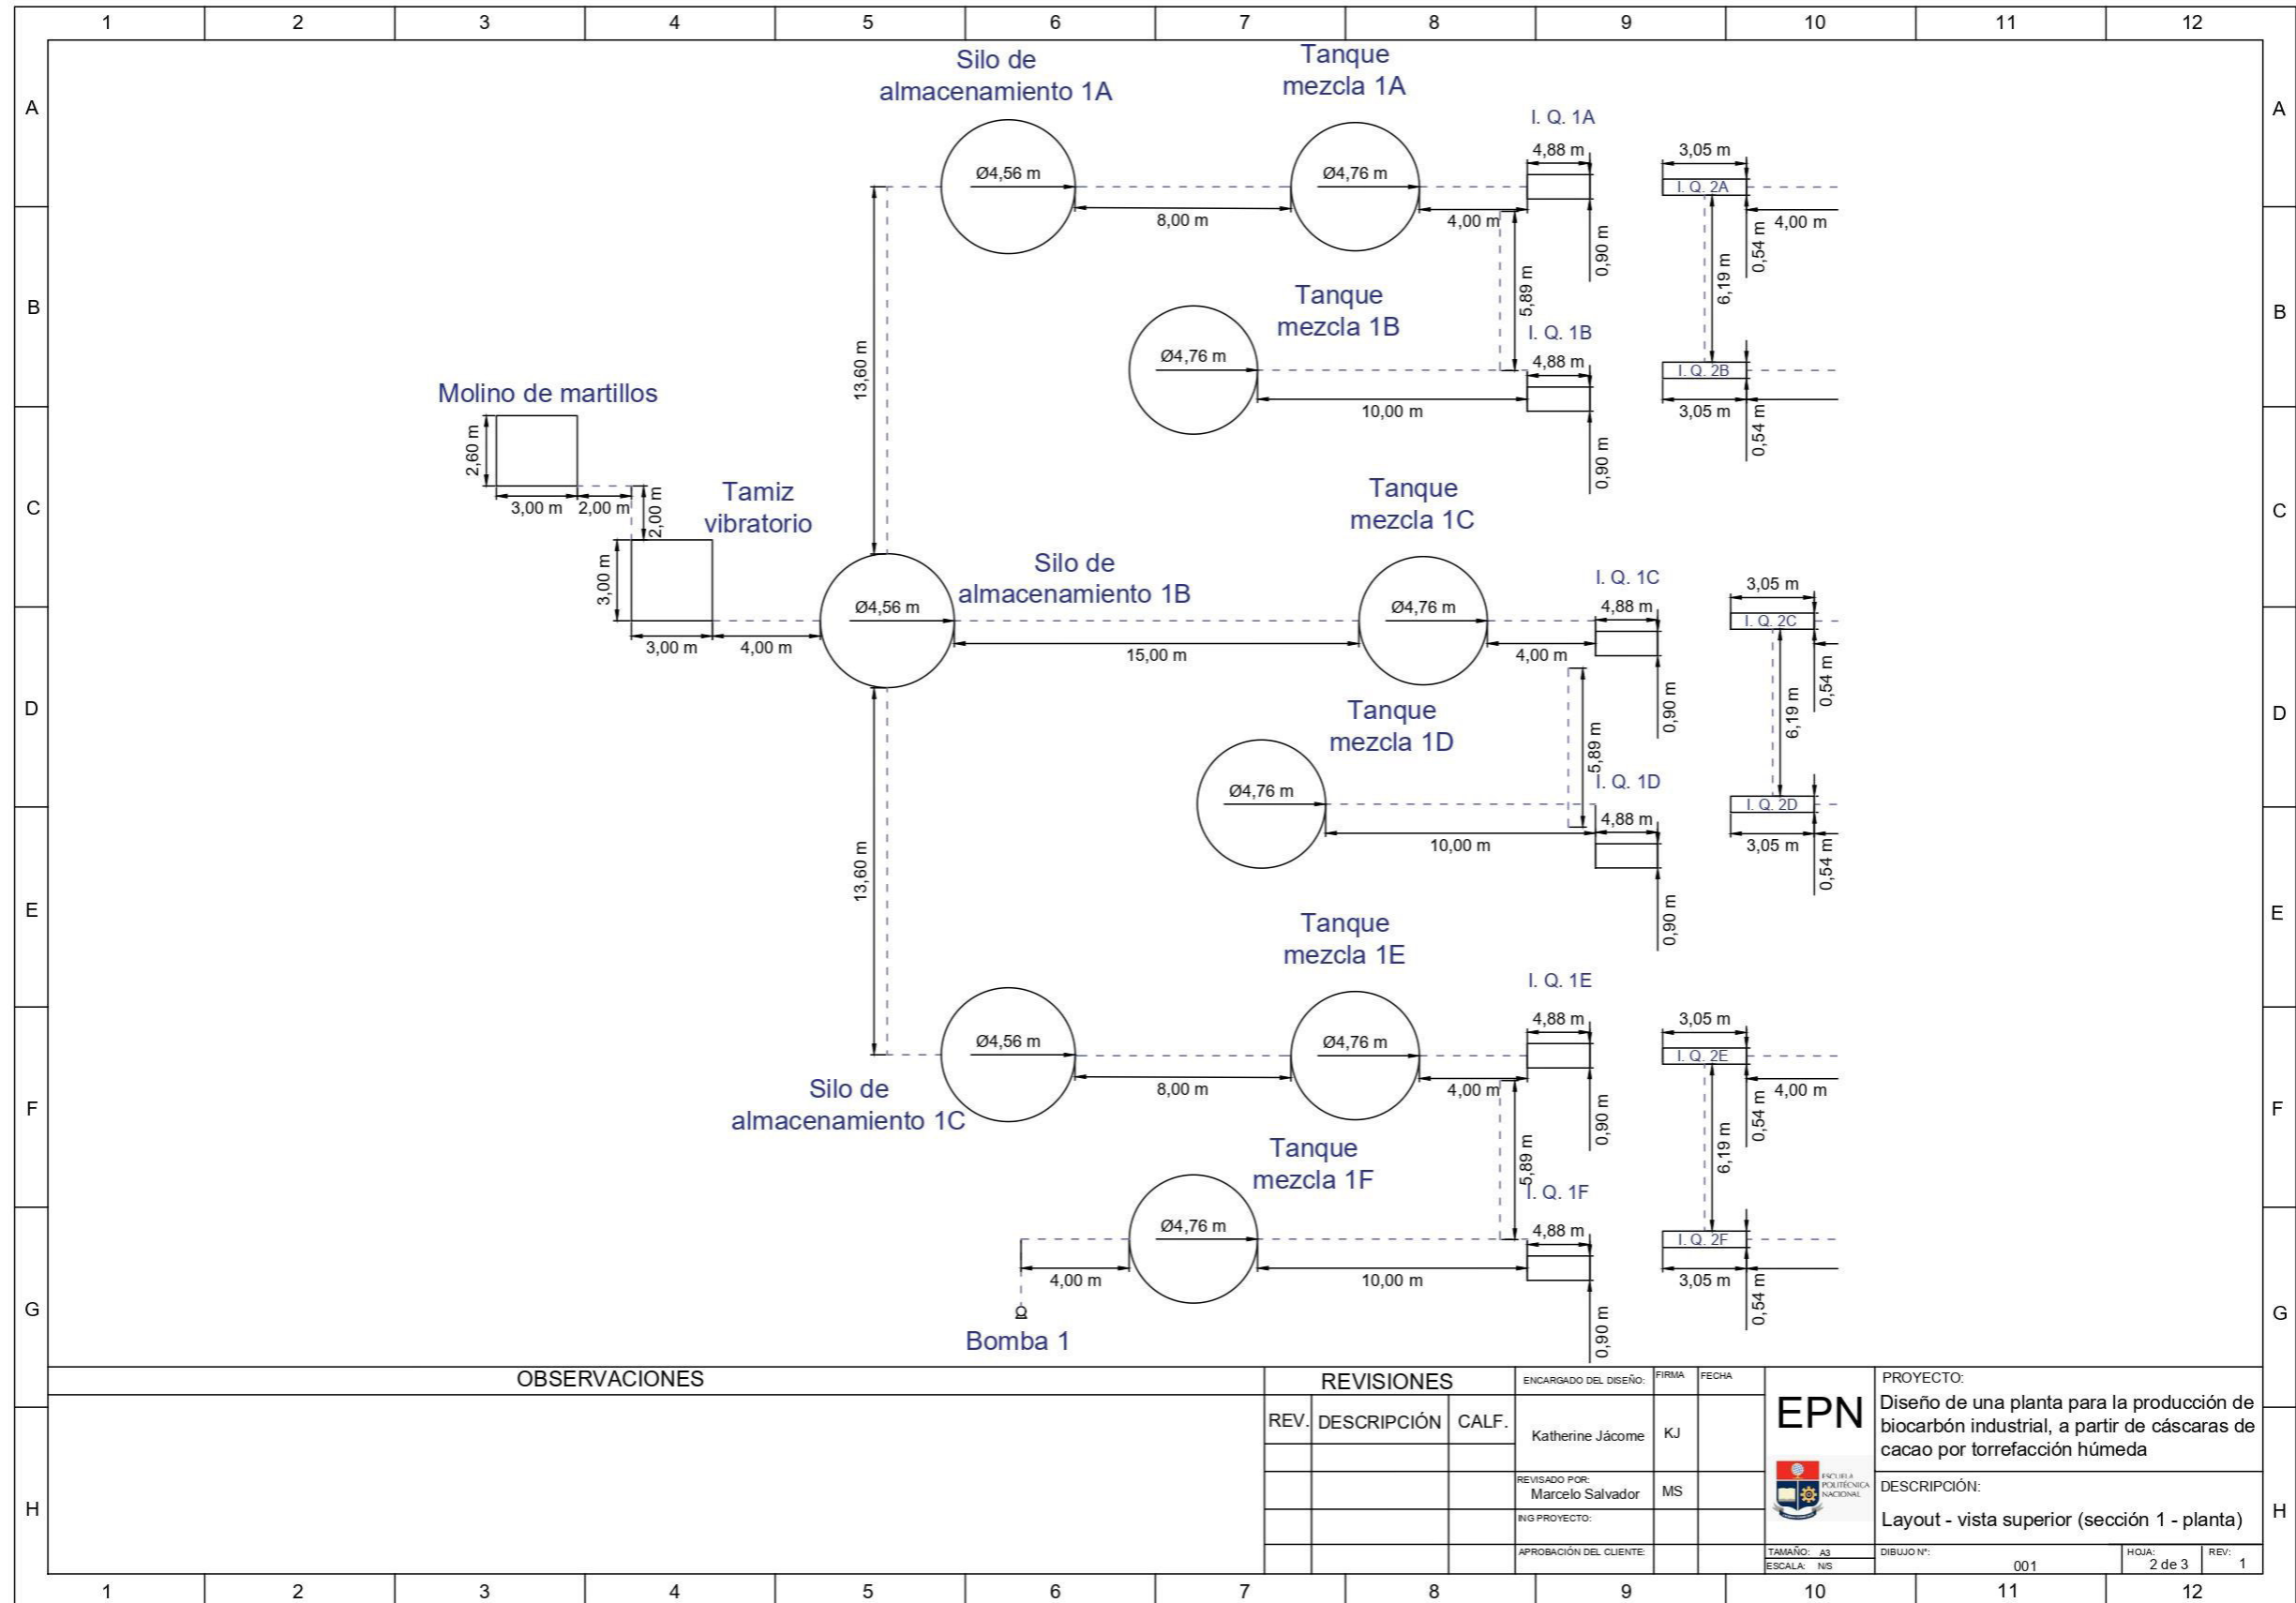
Layout de la planta para la producción de biocarbón a partir de cáscaras de cacao. Plano 2
